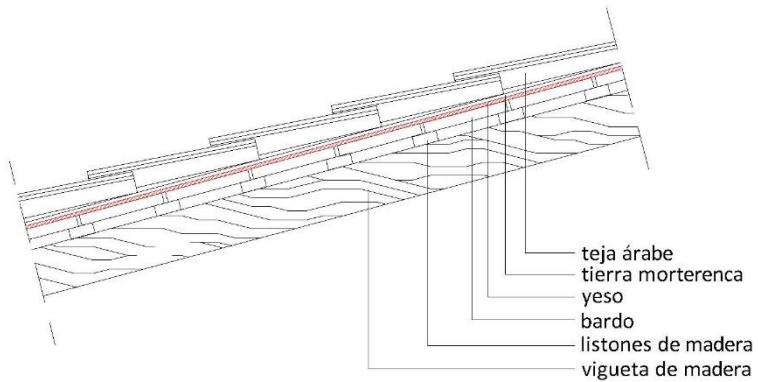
Detalle faldón de cubierta. 2015. Fuente propia.
